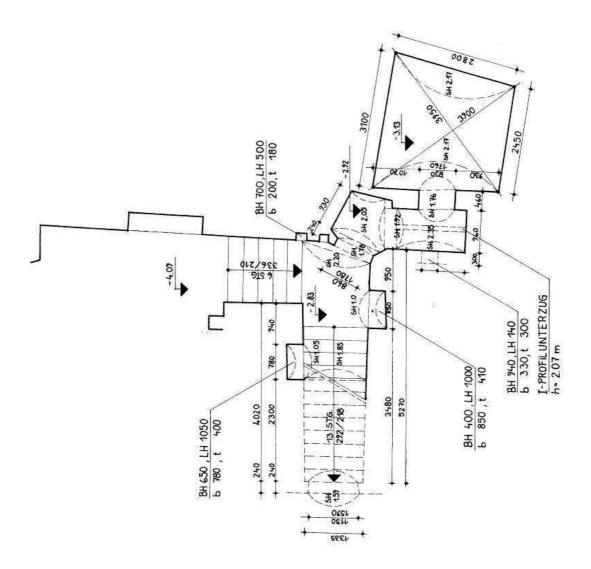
Webergasse 1: Grundriss des Kellers auf halber Treppe, ursprünglich zum Nachbargrundstück Webergasse 2 zugehörig
